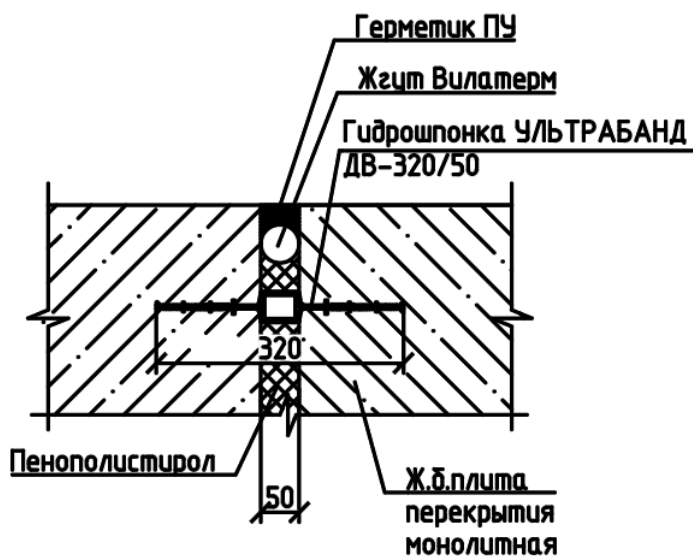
Герметизация деформационного шва монолитного железобетонного перекрытия с применением гидрошпонок ДВ-320/50
